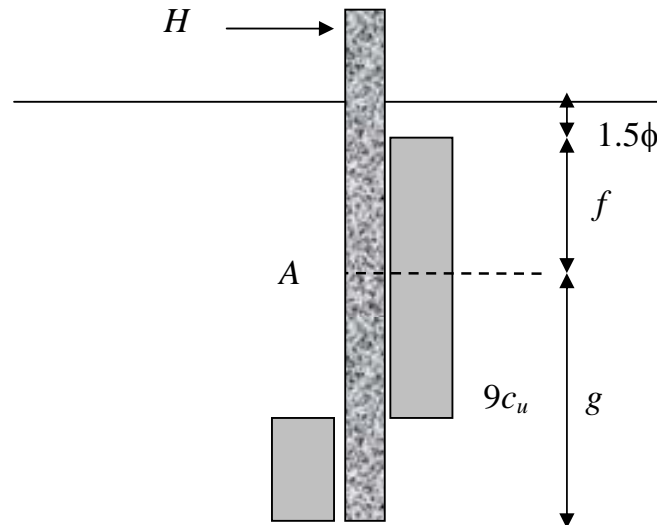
Pilote intermedio sometido a carga horizontal en condiciones de rotura no drenada.
